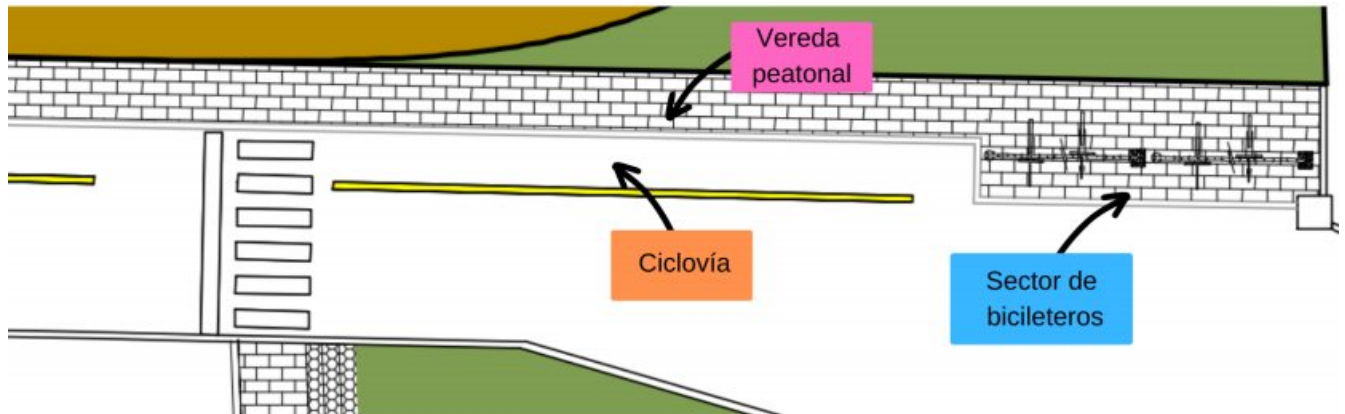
Intervención en planta en Bajada Cristo Pescador; Fuente: elaboración propia
